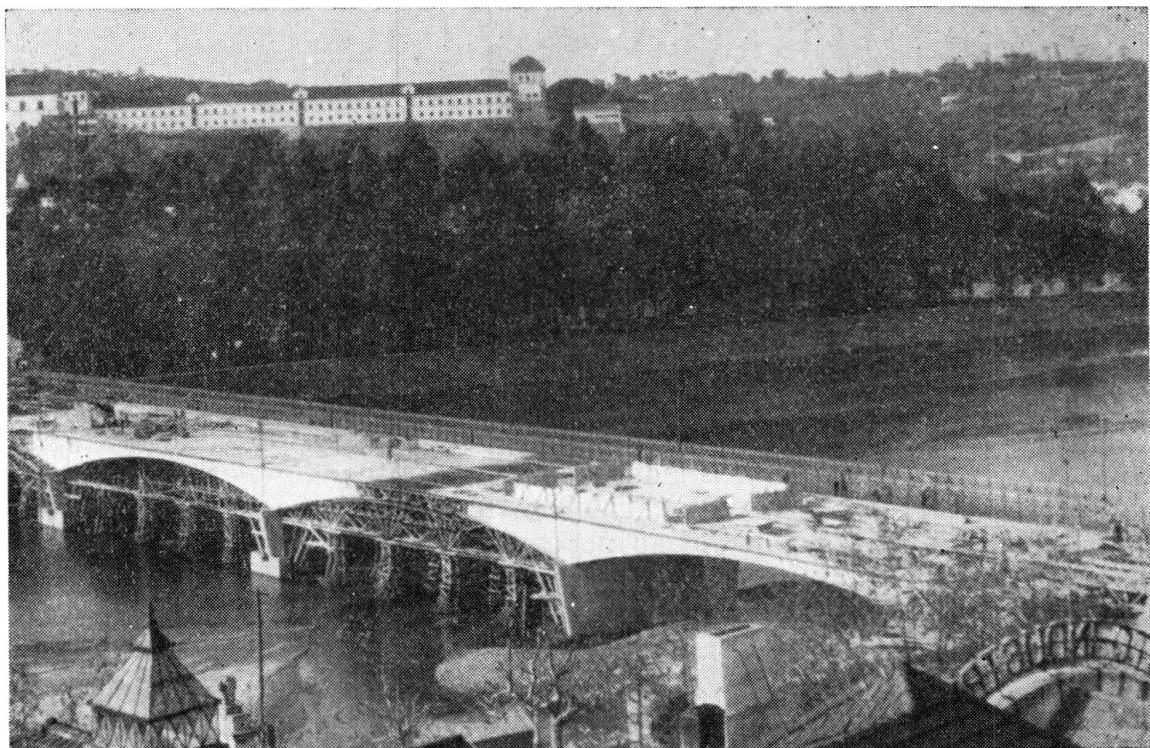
Ponte de Coimbra — fase de construção — Superestrutura em funcionamento isostático por não estarem fechados os vãos 2.º e 4.º
